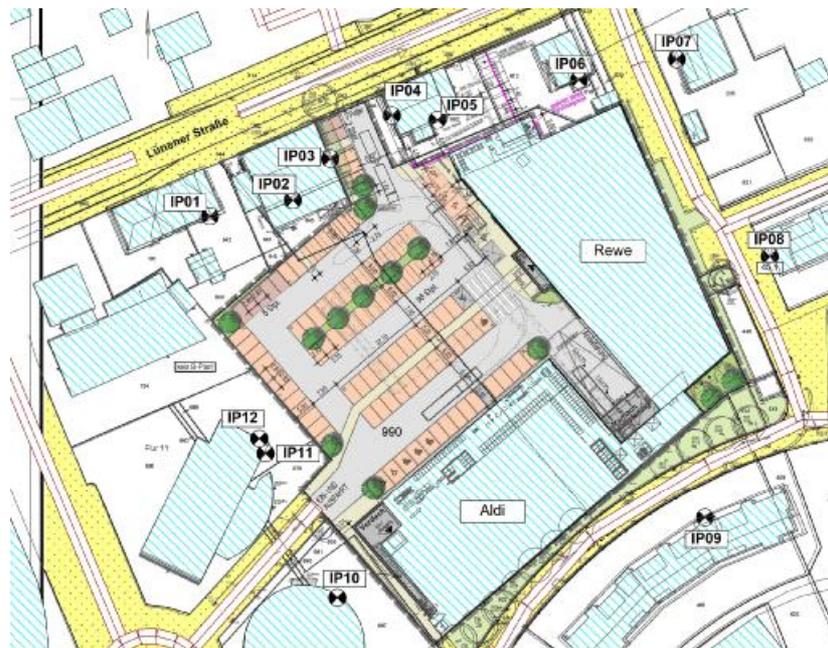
Lageplan mit Lage und Kennzeichnung der Immissionspunkte
